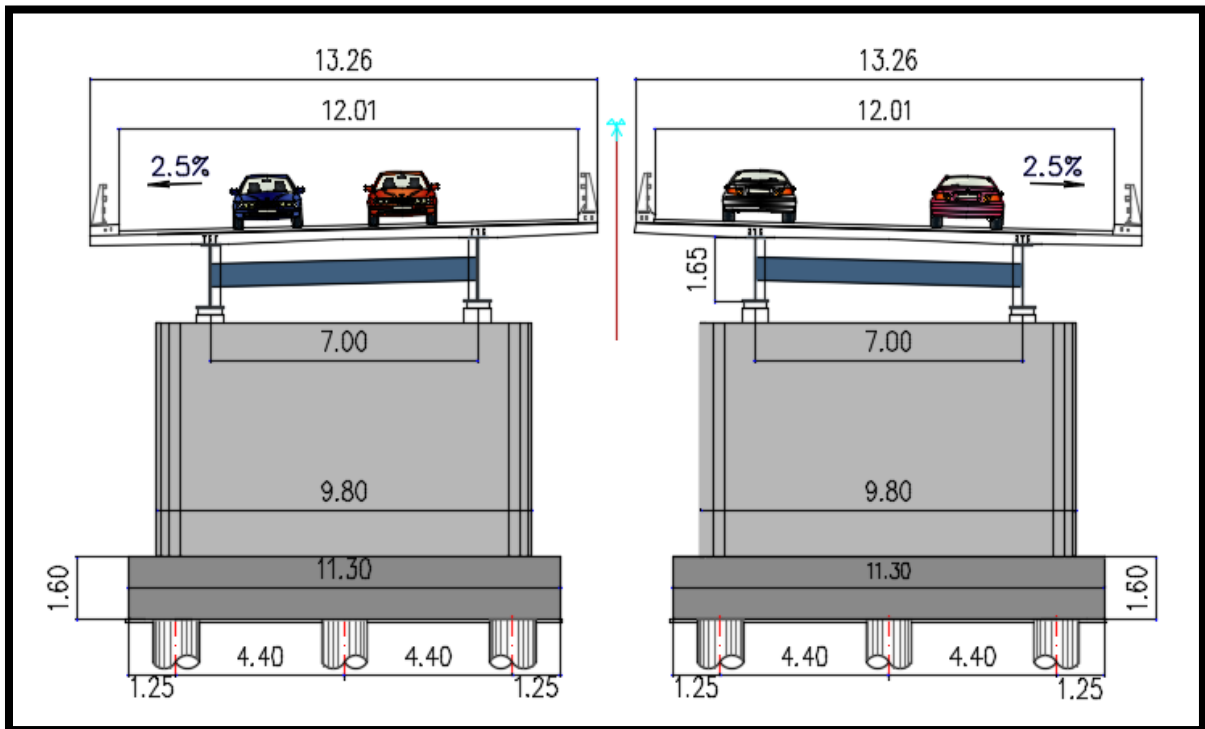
Coupe transversale sur pile VARIANTE 03
